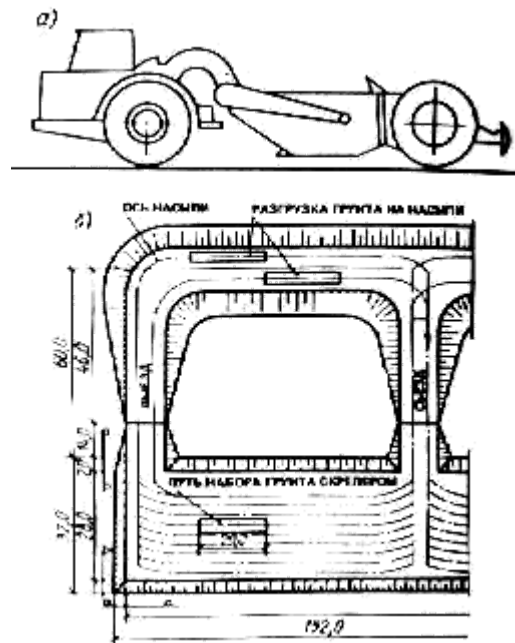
Технологическая схема разработки грунта скрепером ДЗ-20 при отрывке котлована под фундамент многоэтажного промышленного здания:
